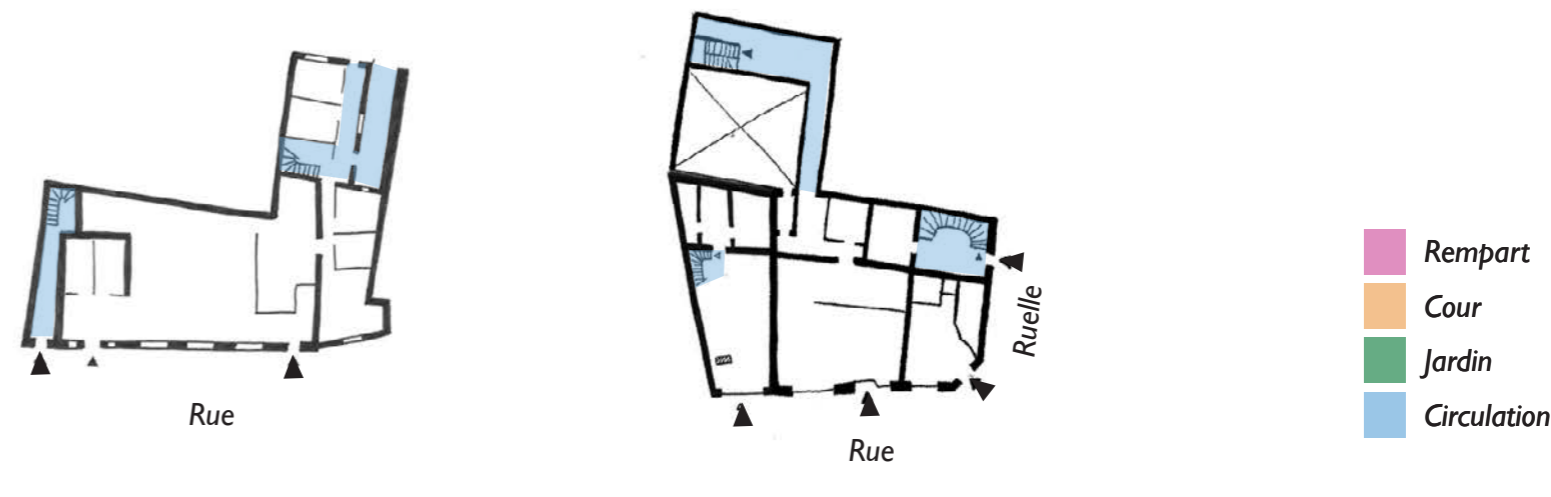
Plans rez-de-chaussée des équipements et bureaux
